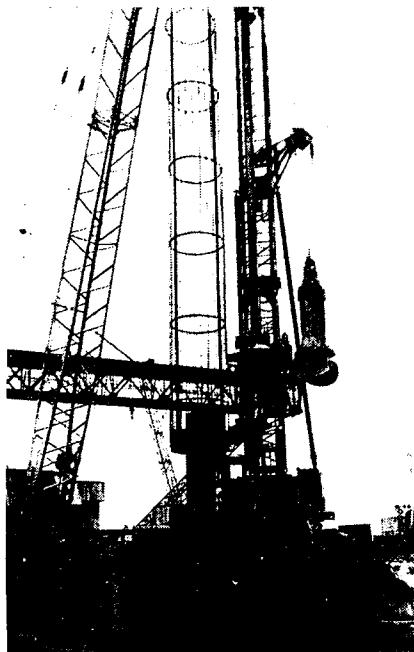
Арматурный каркас опытной буронабивной сваи перед его установкой в скважину
